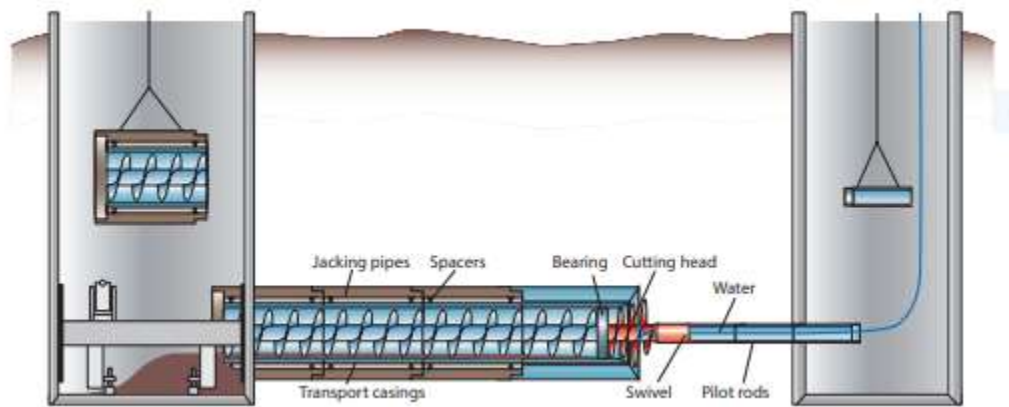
Esquema Auger Boring. Fuente: (Herrenknecht AG & Bohrtec Gesellschaft für Bohrtechnologie mbH, 2016).
